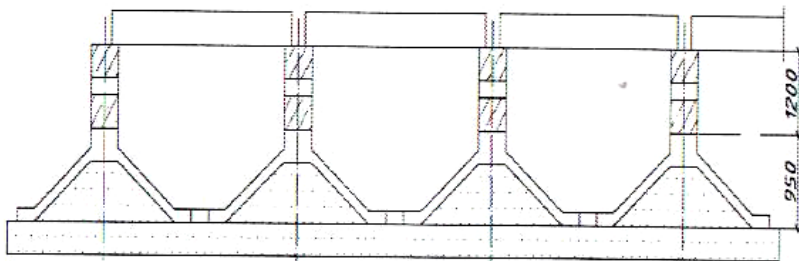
Многоволновые фундаменты-оболочки жилых домов – сборные фундаменты-складки на вечномерзлых грунтах
